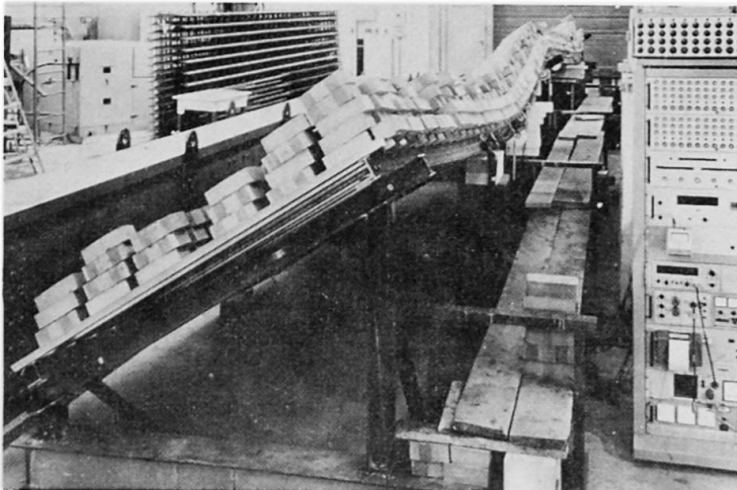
Versuch mit Trapezblechen aus Stahl; Pfetten IPE 100 über 2 x 8,25 m gestützt; Druckstreben in den Drittelpunkten; Dachneigung 62,5 % (32 °)
